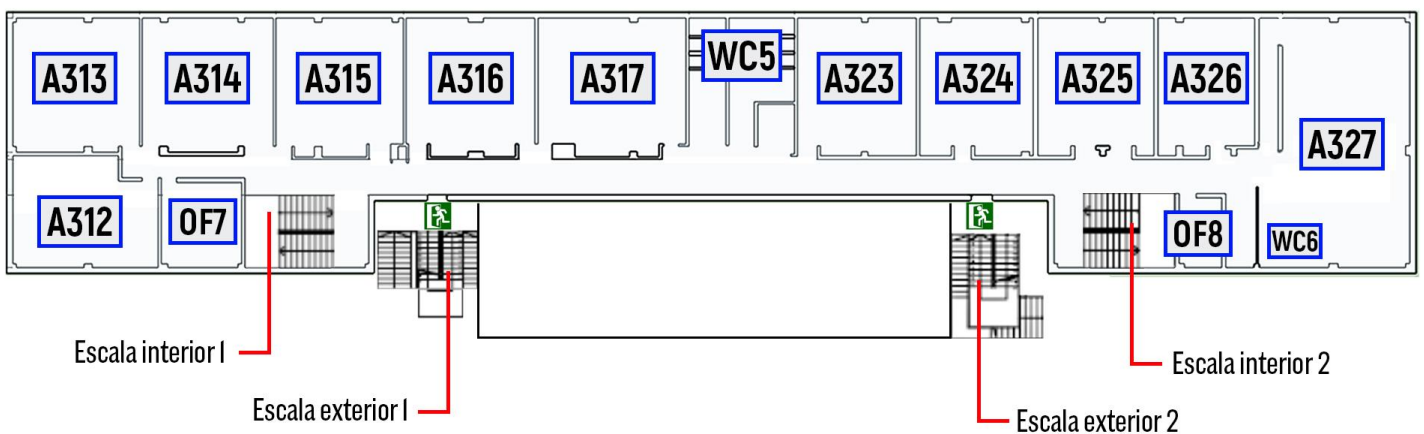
Visió en planta de la planta 3 amb els espais etiquetats.
